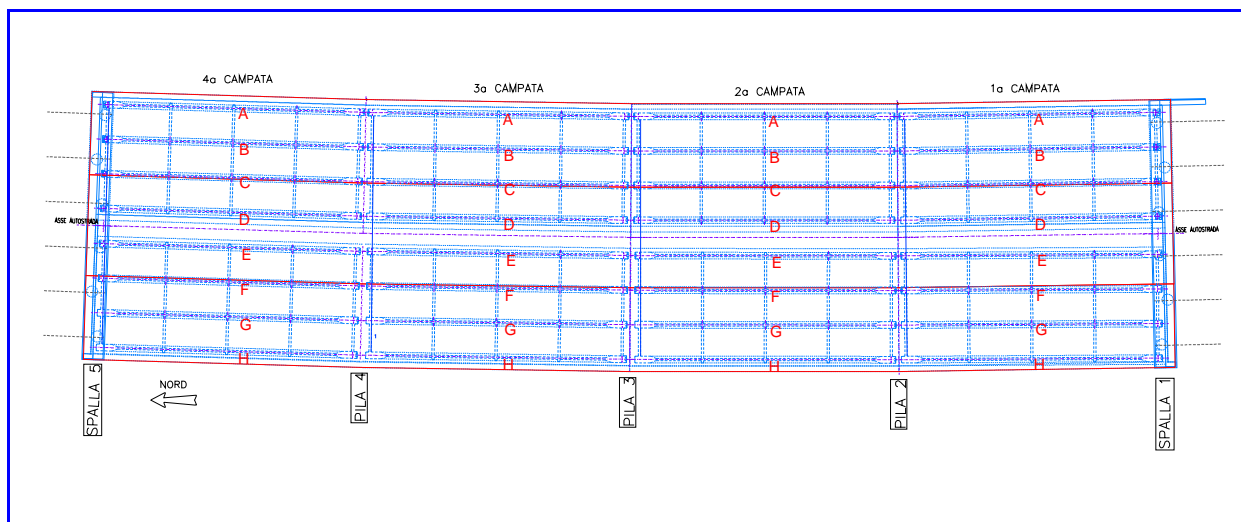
Schema planimetrico del ponte dell'autostrada con ubicazione delle indagini
